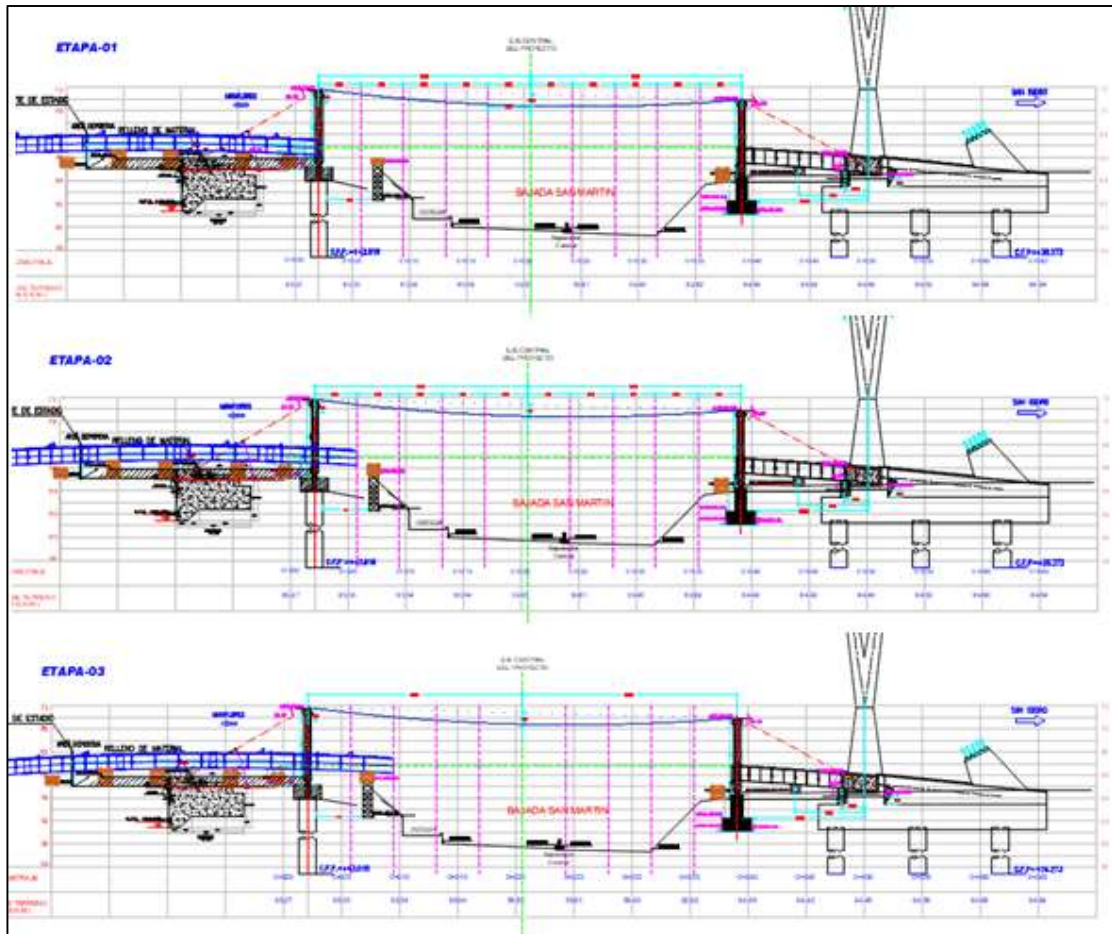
Sistema De Lanzamiento – Vista Elevación
